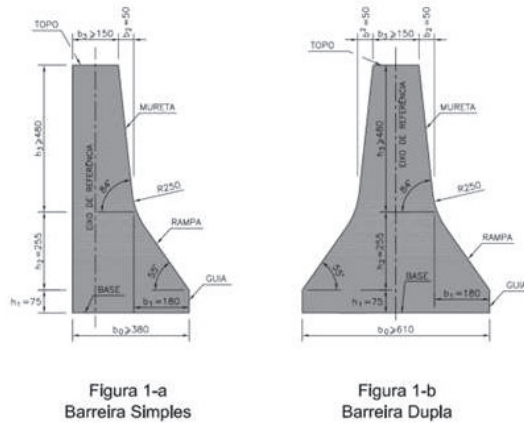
Barreira Rígida prevista em Projeto Padrão PP-DE-L03- 14 à 17.
